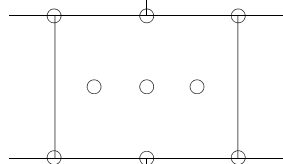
Panneaux PTP-S-035 de dimensions 800 x 625 mm - plans de chevillage en plein (espacement entre chevilles ≥ 200 mm)
